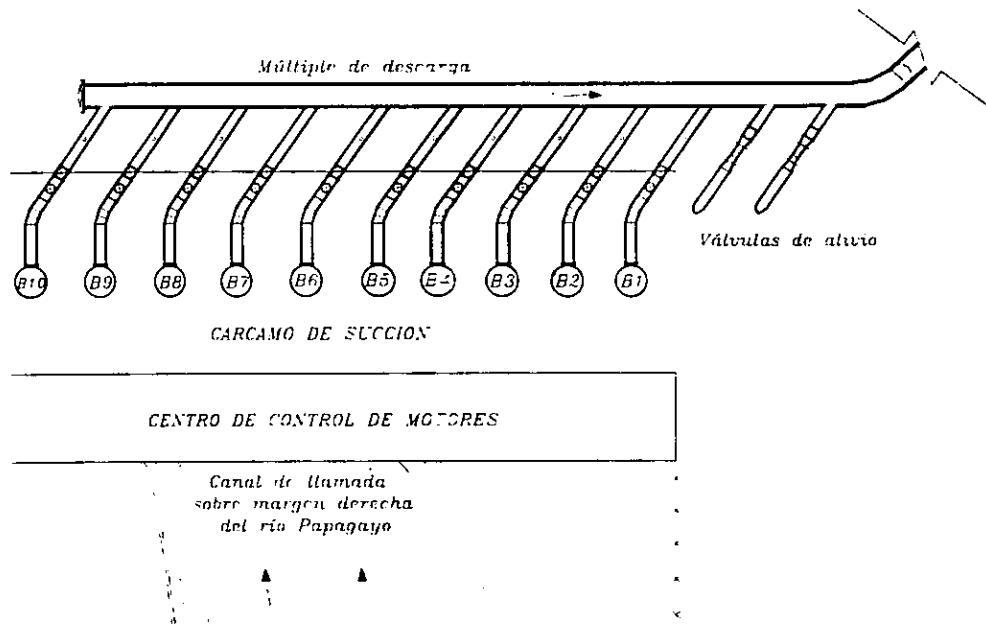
Esquema de la planta de bombeo y línea de conducción
